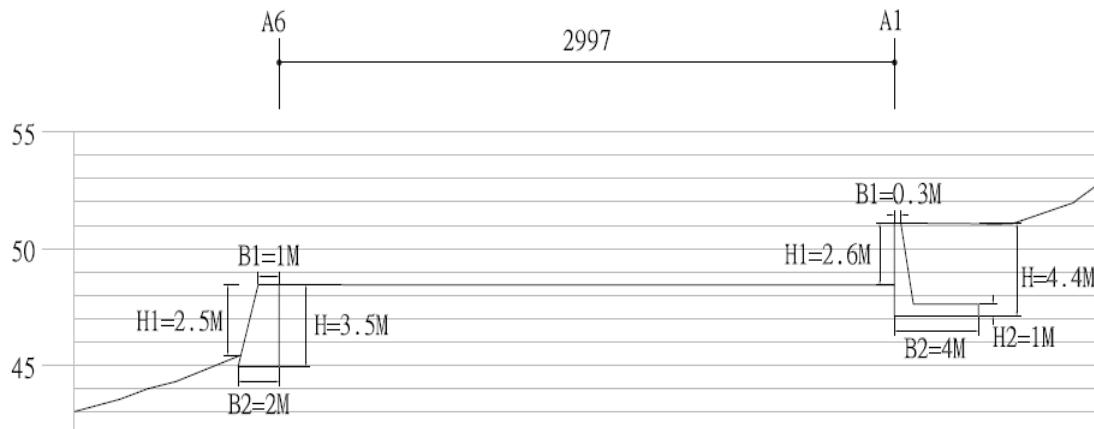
剖面 2(慢濾池)位置剖面圖
